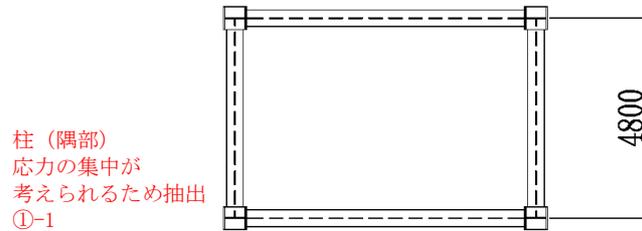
非常用ガス処理系配管支持架構の概略平面図 (EL. 14.2 m)
